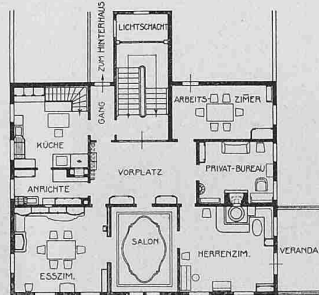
Wohnhaus-Umbau Stähelin in Wattwil. — Grundriss 1:400.
